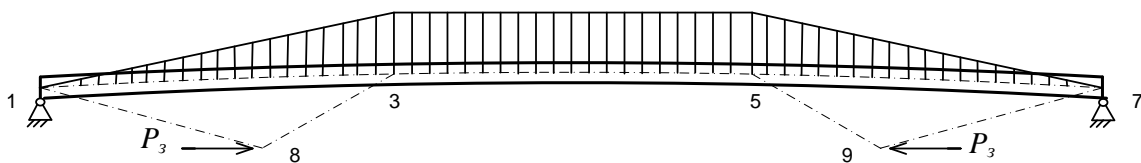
Розрахункова схема металевої частини статично невизначеної комбінованої конструкції, попередньо напруженої за допомогою затяжки.
